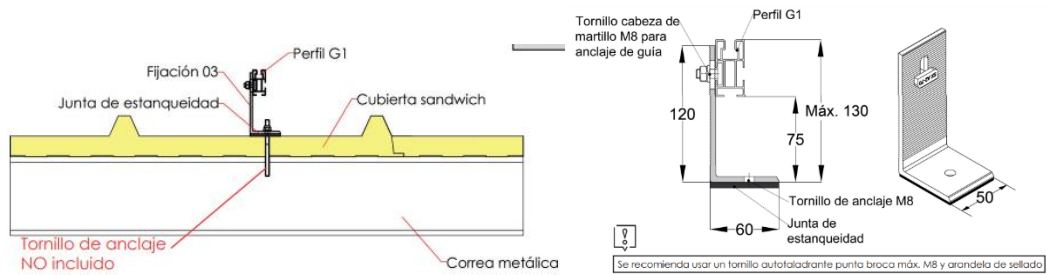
Soporte de paneles y disposición sobre cubierta
